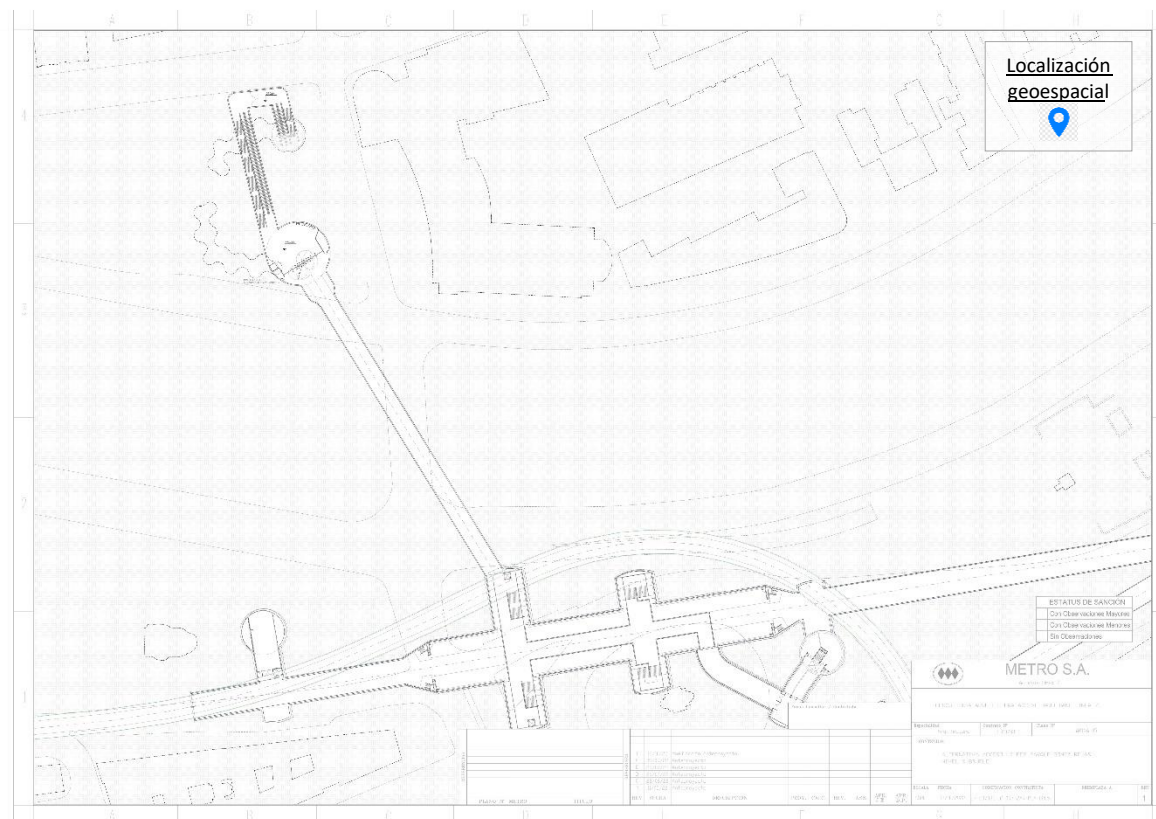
Plano Planta Anteproyecto Acceso Baquedano Línea 7 en Parque Gómez Rojas
